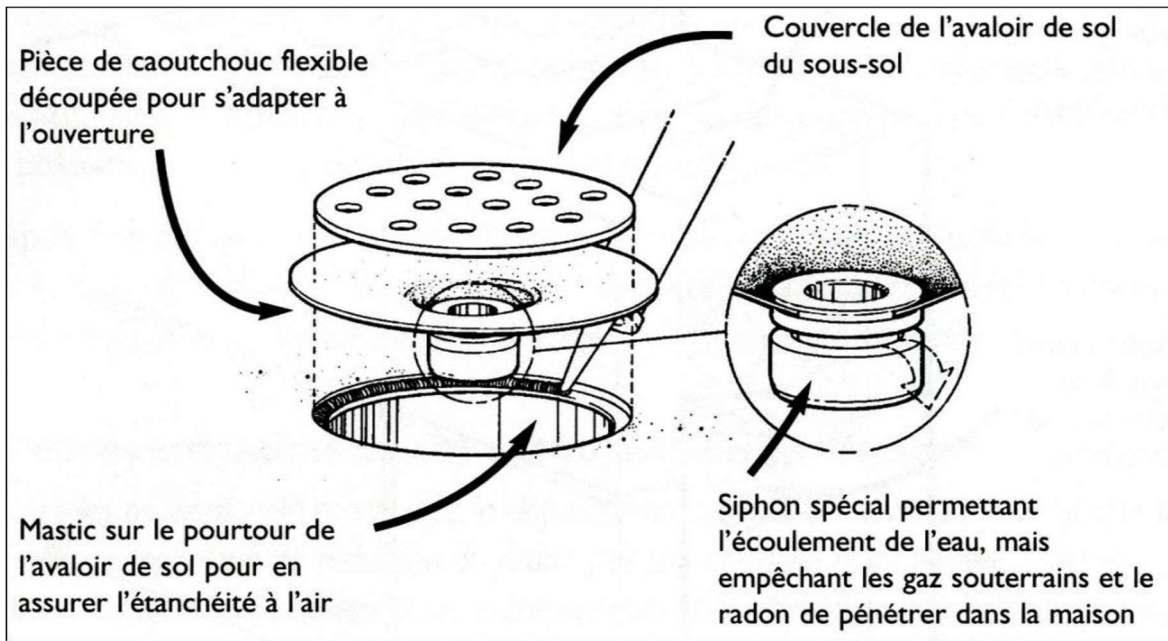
Étanchéisation des orifices d'évacuation d'eau (avaloirs de sol) d'un plancher sur sol
